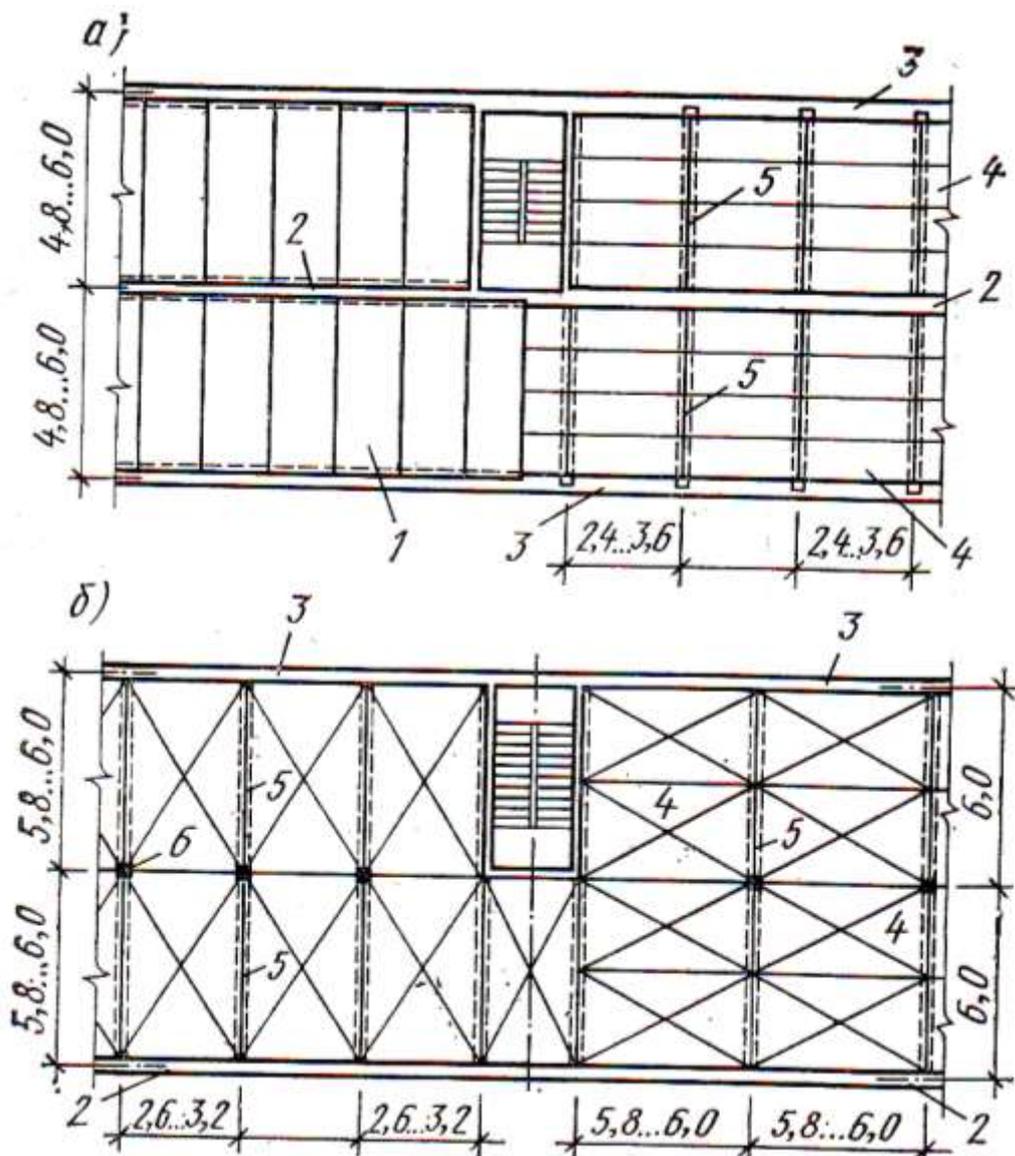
Конструктивные схемы плитных перекрытий:
